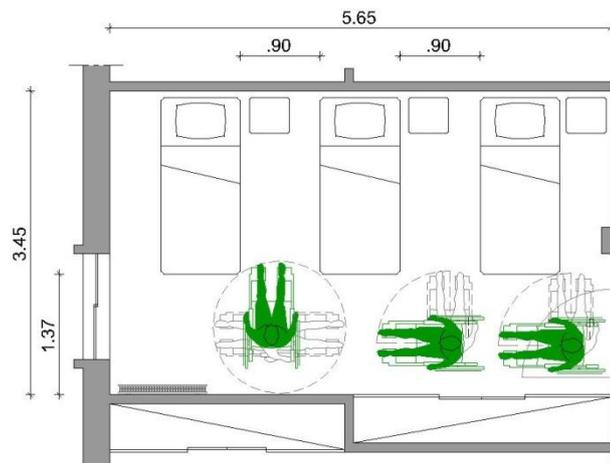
ILPI 1 - 1º pavimento - Planta baixa quarto.
